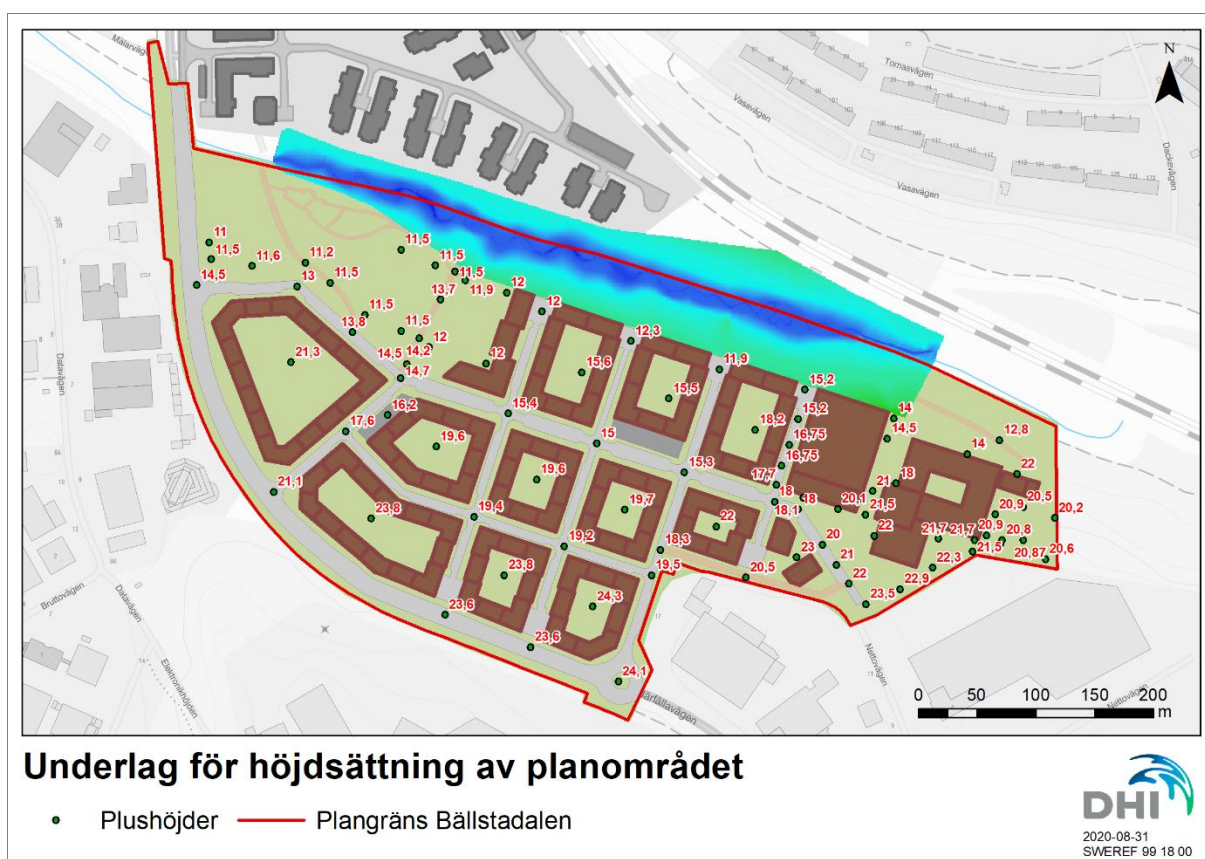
Planerad översvämningshantering för planområdet Bällstadalen.
